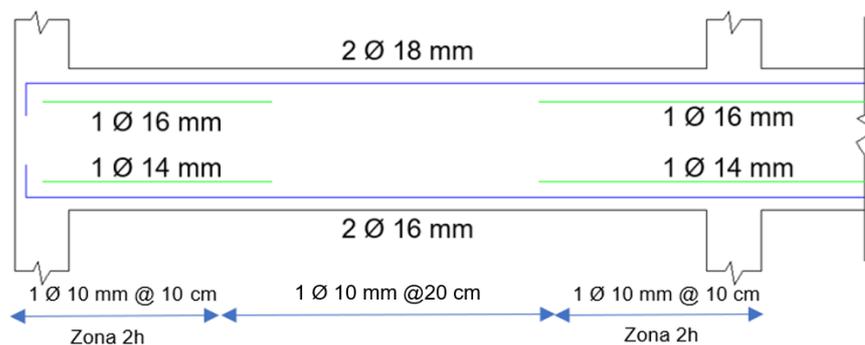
Refuerzo longitudinal de viga 25x40.
